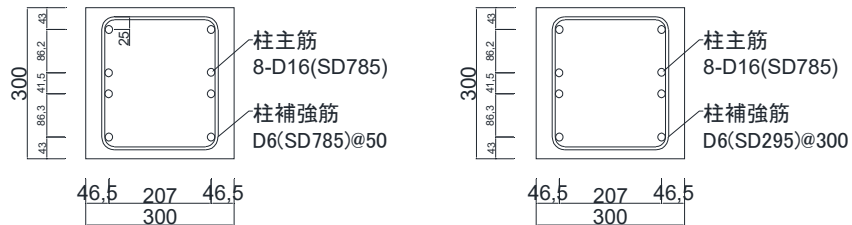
試験体 D-4 柱断面詳細図 (左:柱, 右:パイルキャップ内柱)
